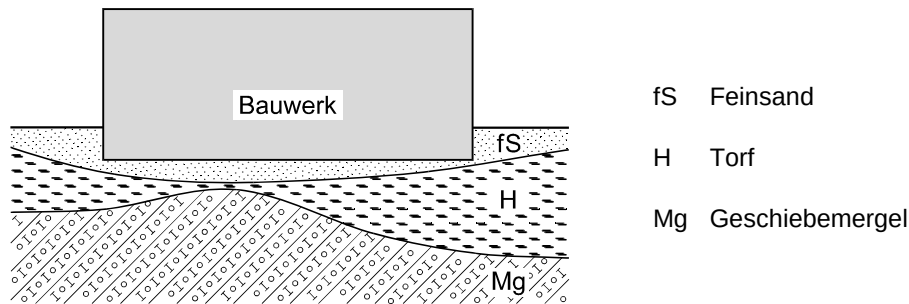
Baugrund unter einem geplanten Bauwerk
